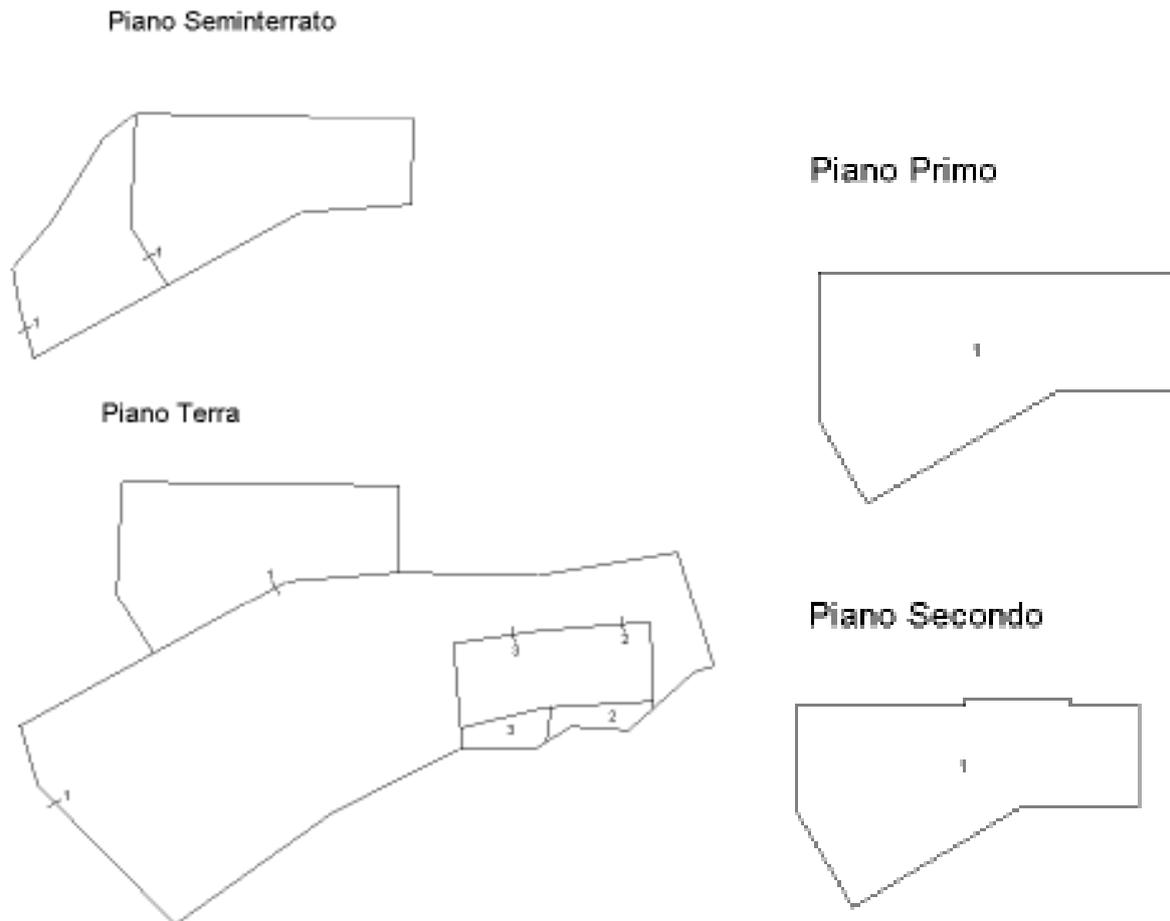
Stralcio Elaborato planimetrico particella 1029 foglio 6 del comune di Caraffa di Catanzaro
